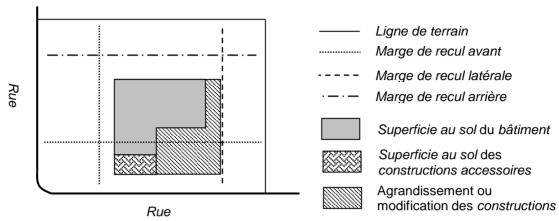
B Agrandissement ou modification des constructions accessoires
